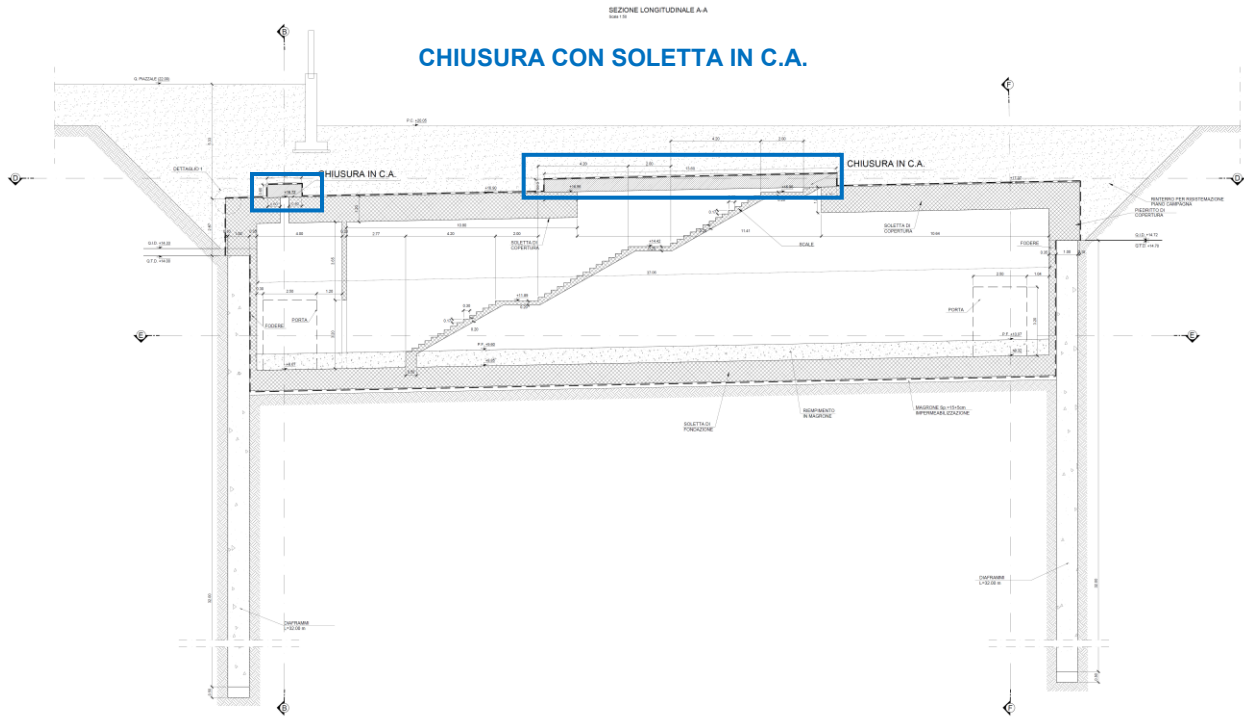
Uscita STI – Sezione longitudinale A-A - Progetto di Variante
